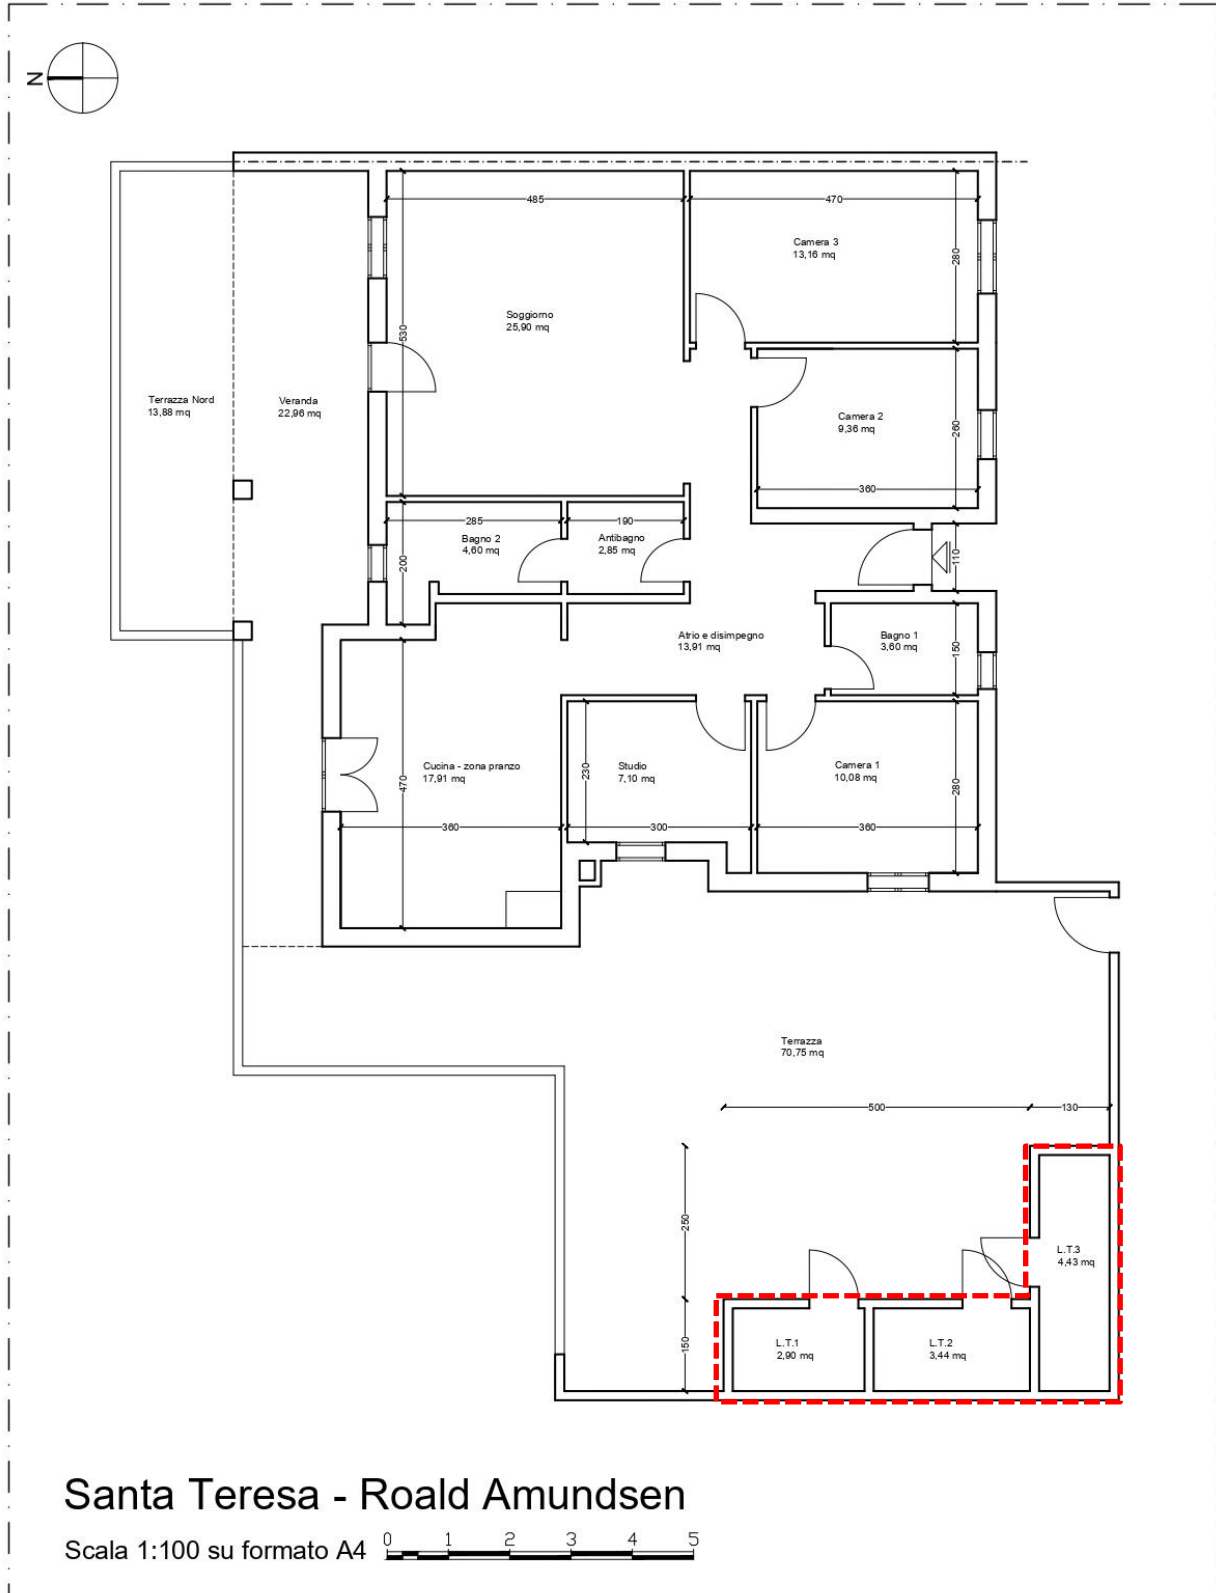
Planimetria stato di fatto con evidenziati gli elementi difformi rispetto a quanto approvato
